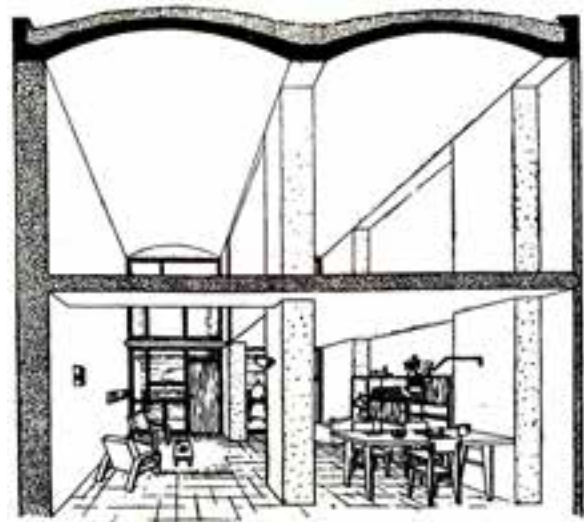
Coupe sur une maison familiale type a flanc de coteau
